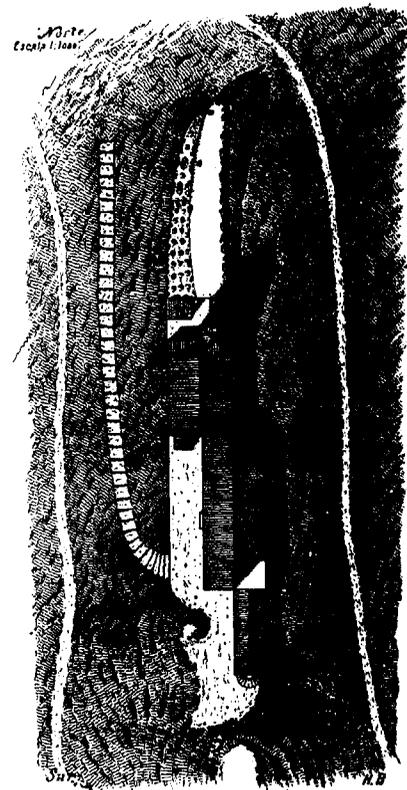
ª—Planta y vista cenital de la ermita y casa-hospedería de Rocacorva.
